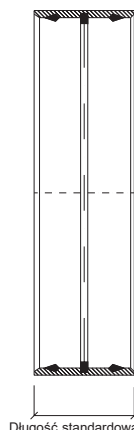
Łańcuch uszczelniający w murze betonowym
